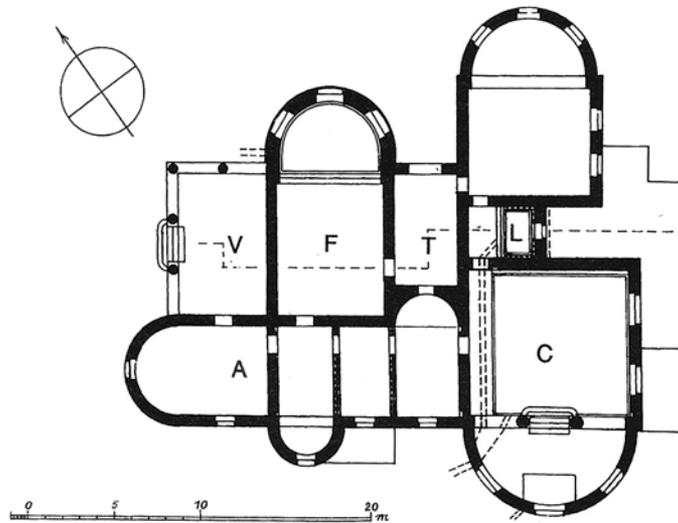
Rekonstruktion und Grundriss der Privatbades in der Palastvilla in Nanning
